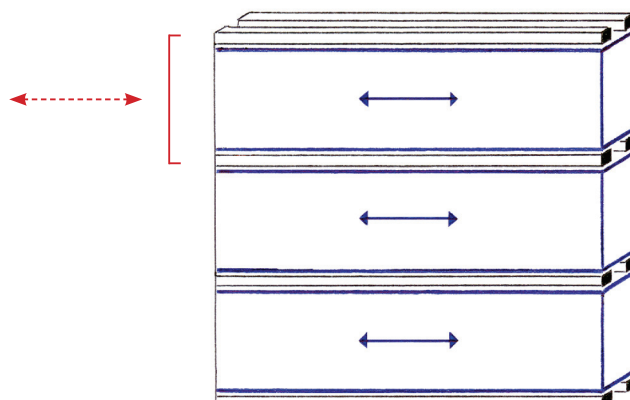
Schéma : mouvement différencié des segments de maçonnerie hourdée, réduisant le risque de fissuration diagonale destructive.
